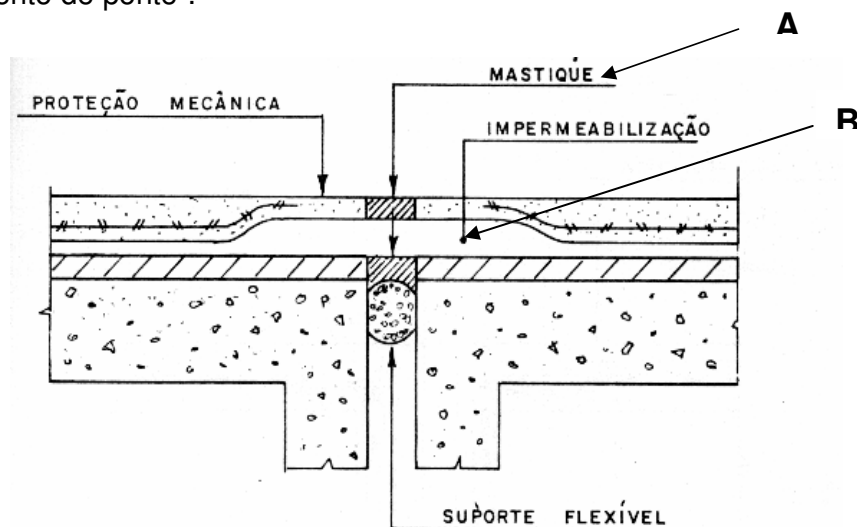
Proteção Mecânica para Impermeabilização de Junta Perimetral
